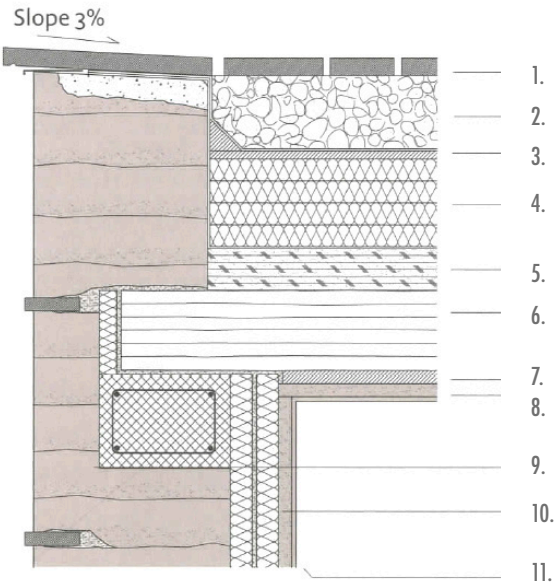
, 148. Construcción techo planta baja con piezas cerámicas.
